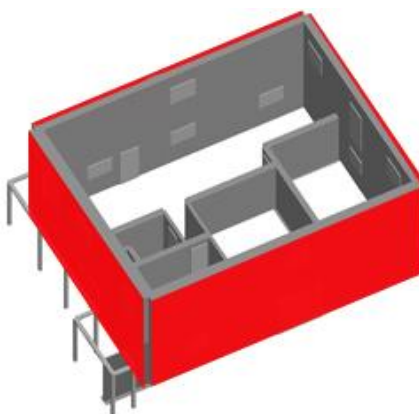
Esquema de execução de reboco armado numa face de todas as fachadas
